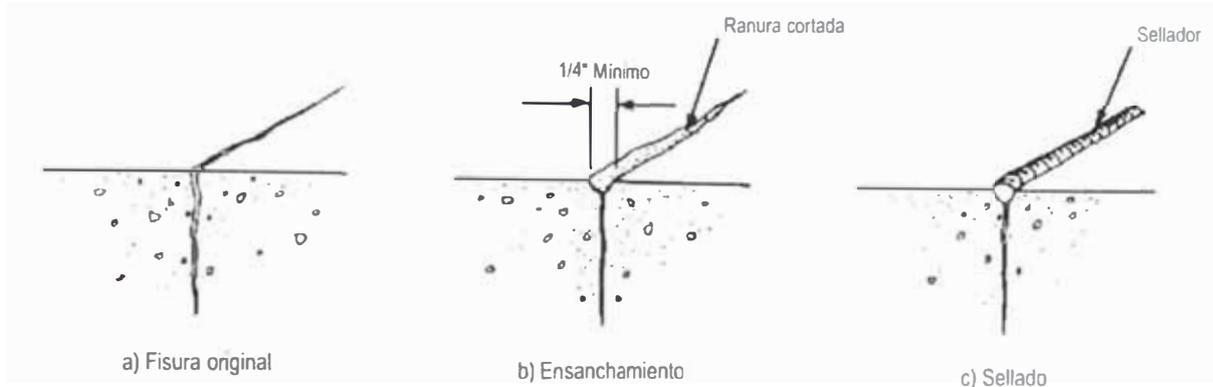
Reparación de fisuras mediante el ensanchamiento y sellado
